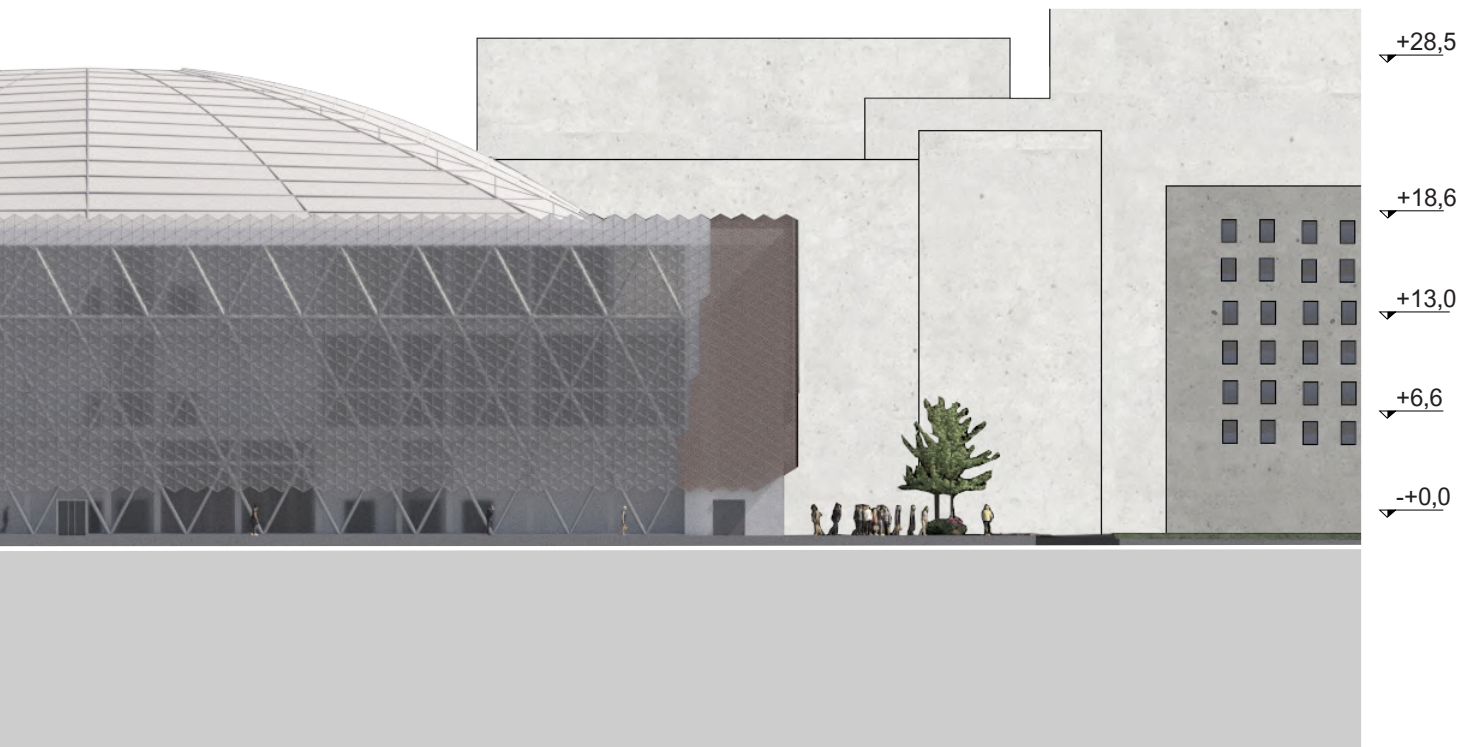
Vista esterna dell'edificio dalla piazza di ingresso
